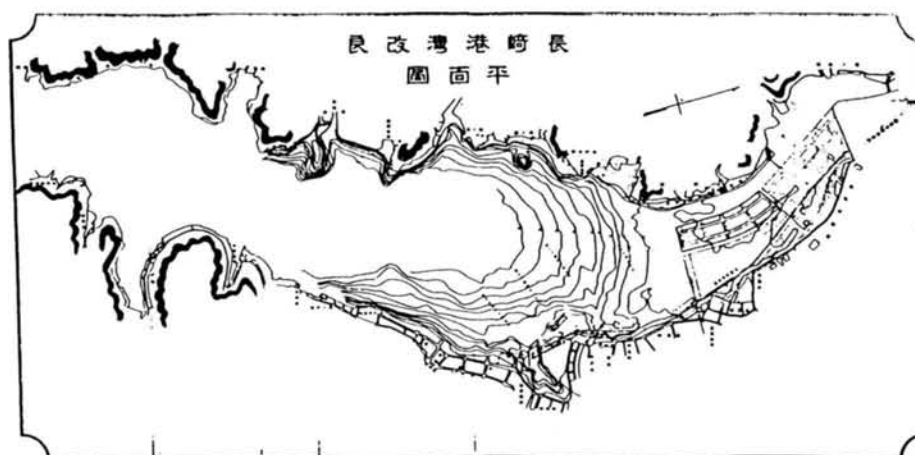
長崎港湾改良工事平面図(明治36年11月作成)<sup>28)</sup>
